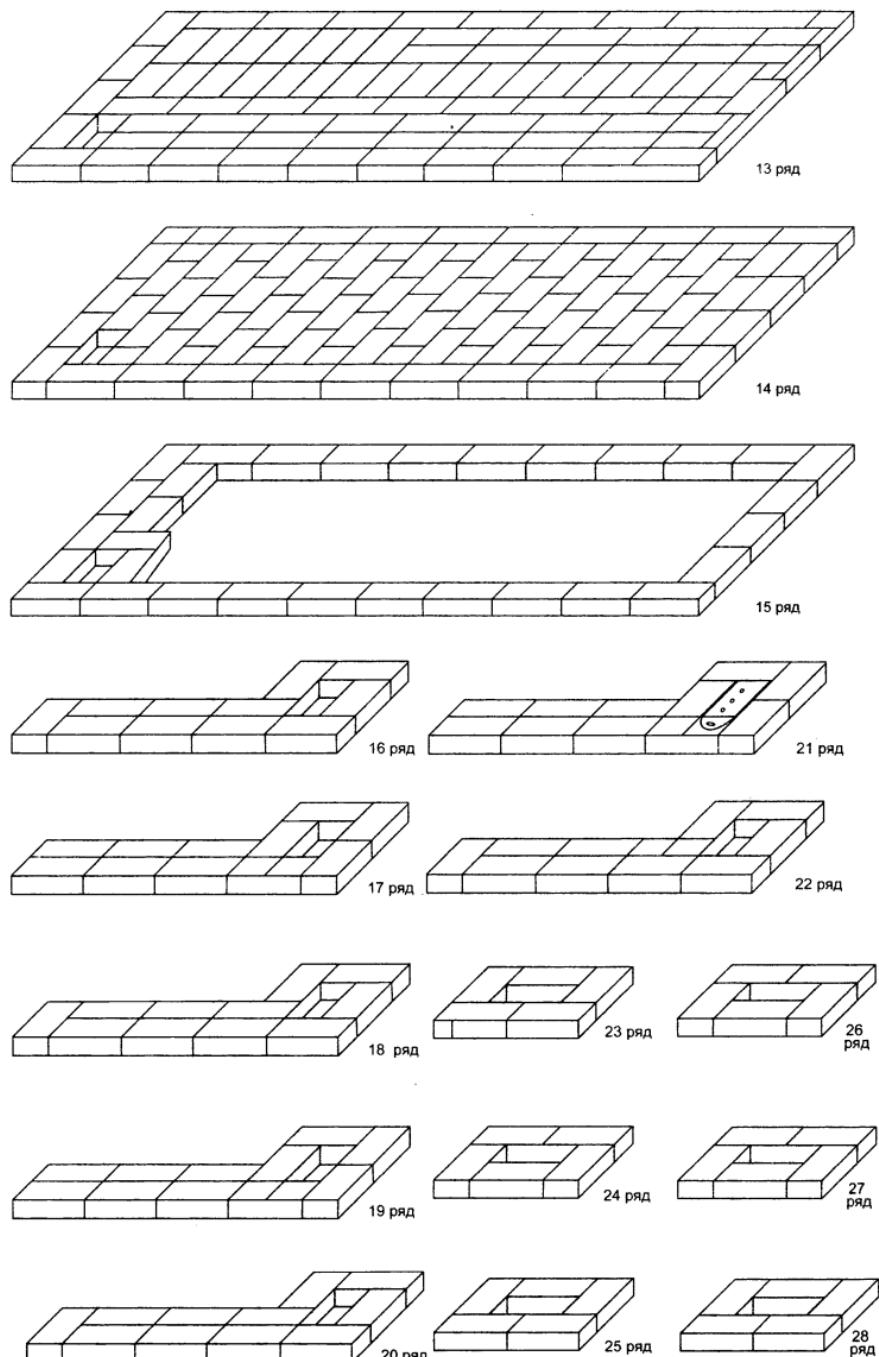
Кладка отопительной печи № 4А с лежанкой (продолжение)
